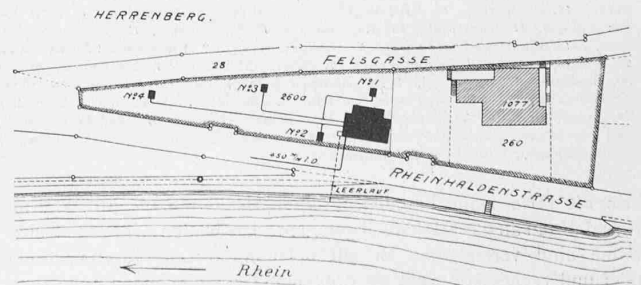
Lageplan des Pumpwerks Rheinhalde. — 1:2000.
